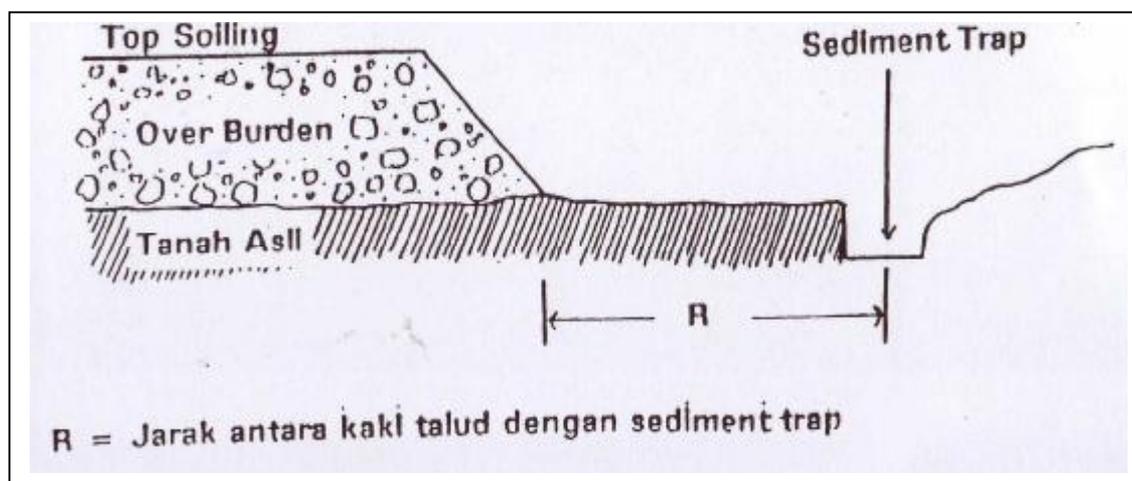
Pengambilan Tanah Pucuk di Mining Pit dan Cara Penambangan Tanah di atas Over Burden di Waste Dump
